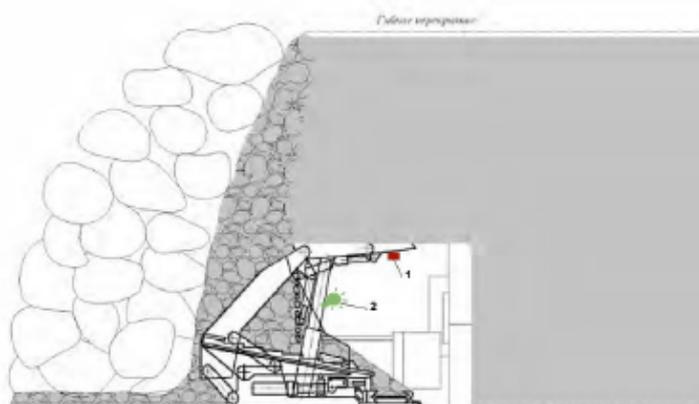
схема установки прибора ZET 7156. 1-сейсмометр ZET 7156, 2- лампочка-индикатор разрушения пород.
